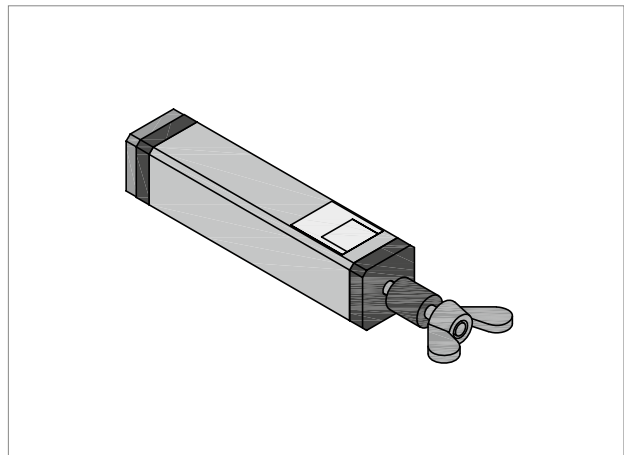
Schöck Tronsole® Typ P: Montageelement
